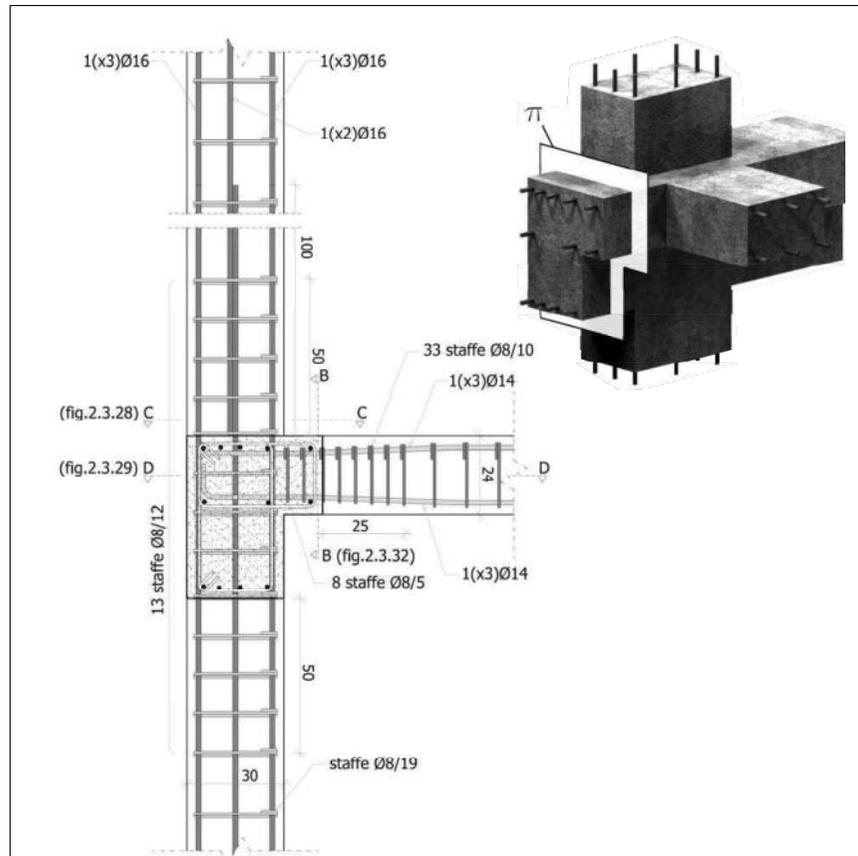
Particolare 1: sezione A-A sulla trave a L
